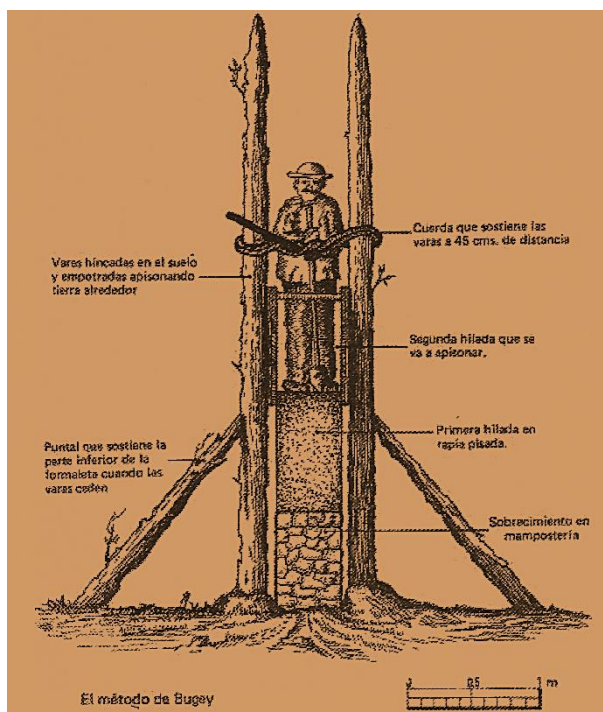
Colocación de encofrados para construcción de muros de tapia.
